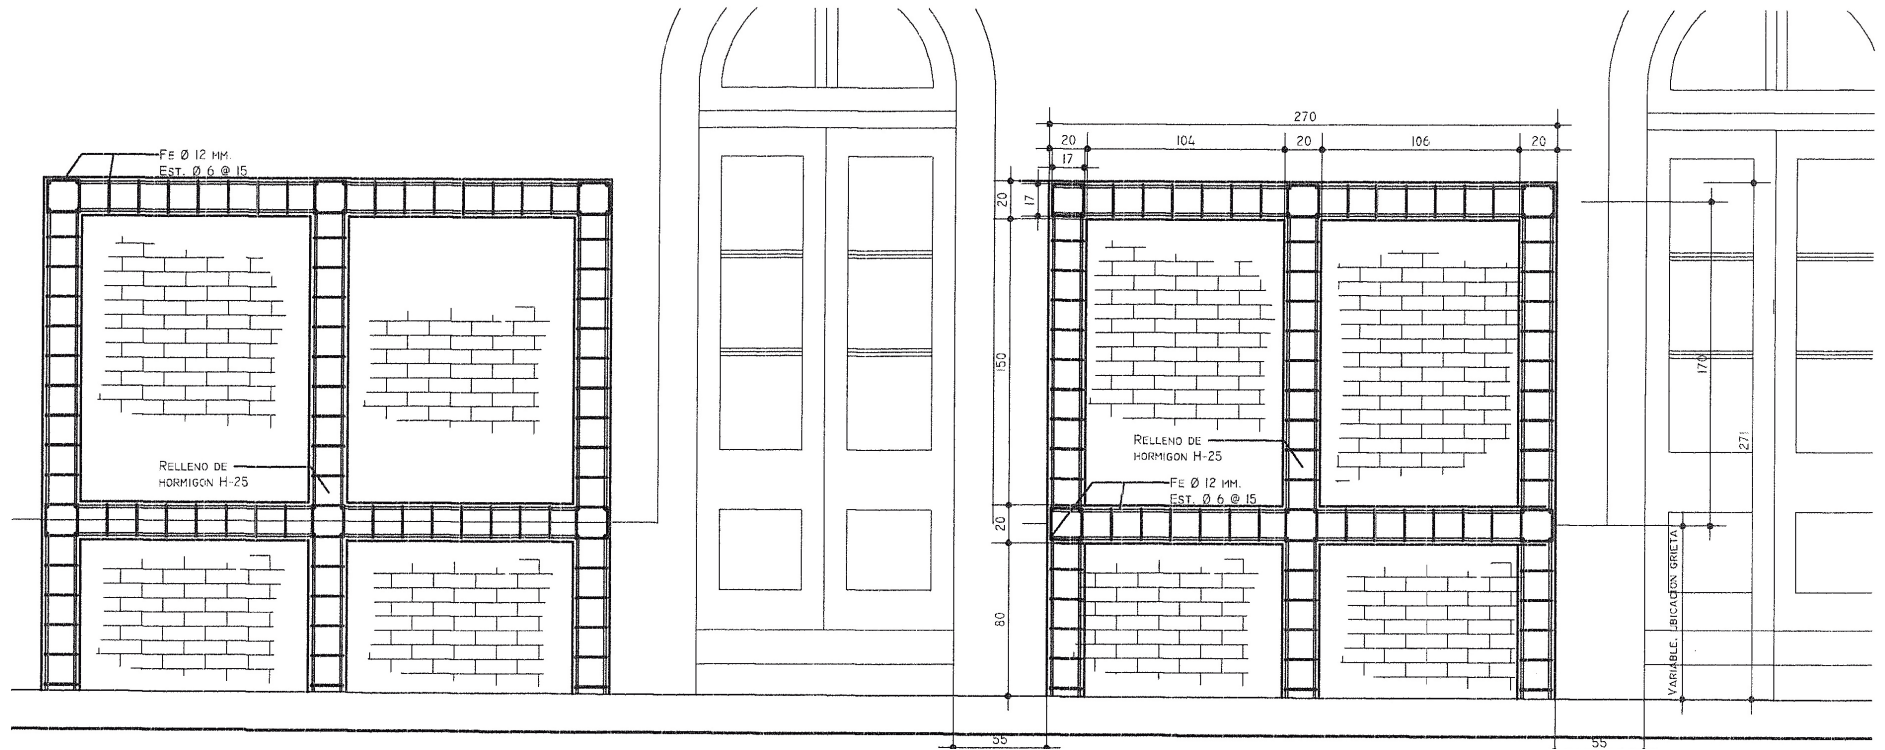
Aplicación de Solución en Muros de Albañilería del Tipo Marcos de Hormigón Armado, Elevación
